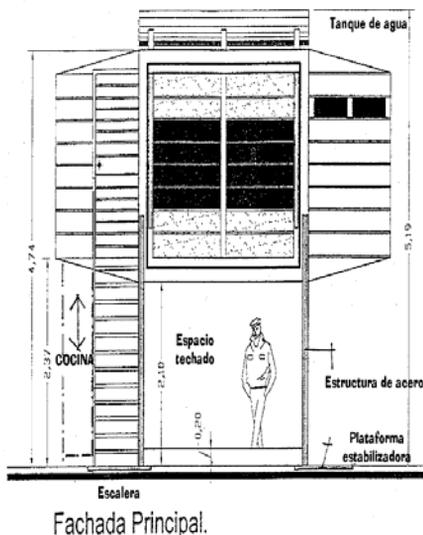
Vista de la fachada principal del habitáculo A, ya suspendido sobre la estructura de acero.
